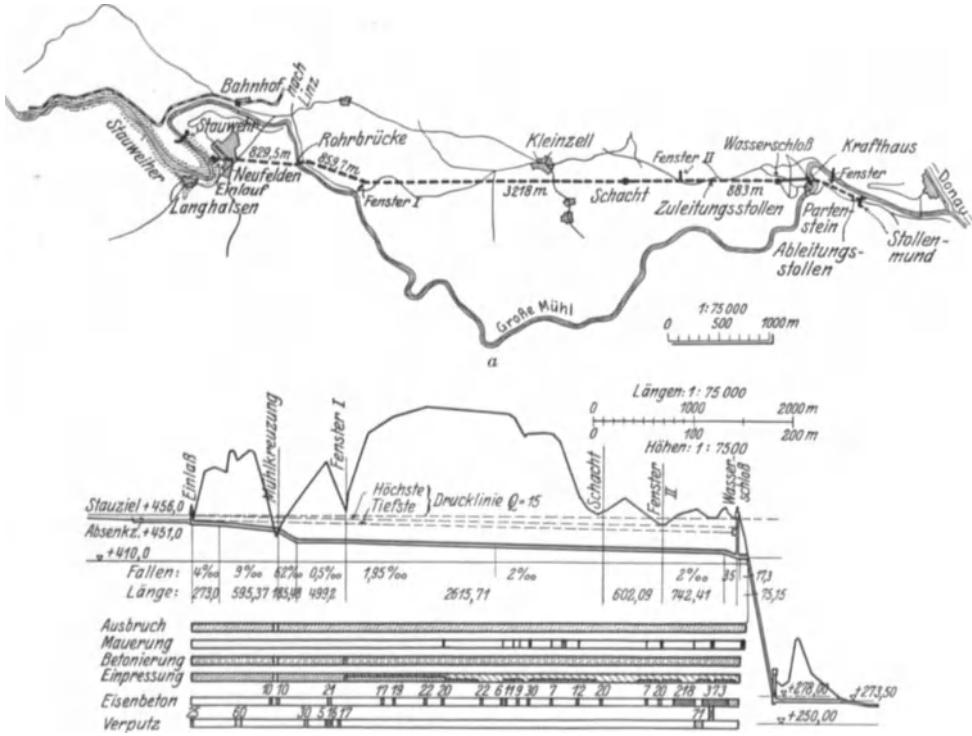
Partensteinwerk. (Randzio in Bautechn.) a Übersichtsplan. b Längenschnitt mit Übersicht der Druckstollenausführung.
